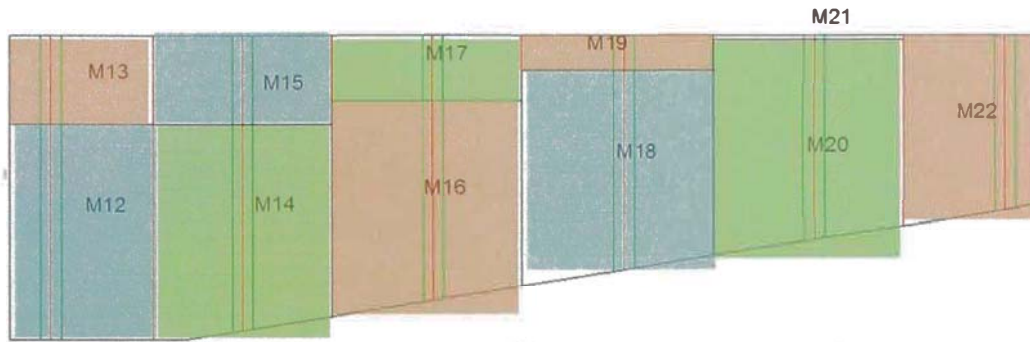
Sectorización en Perfil Faja 1 (muros) – Eje C (Fuente propia)
